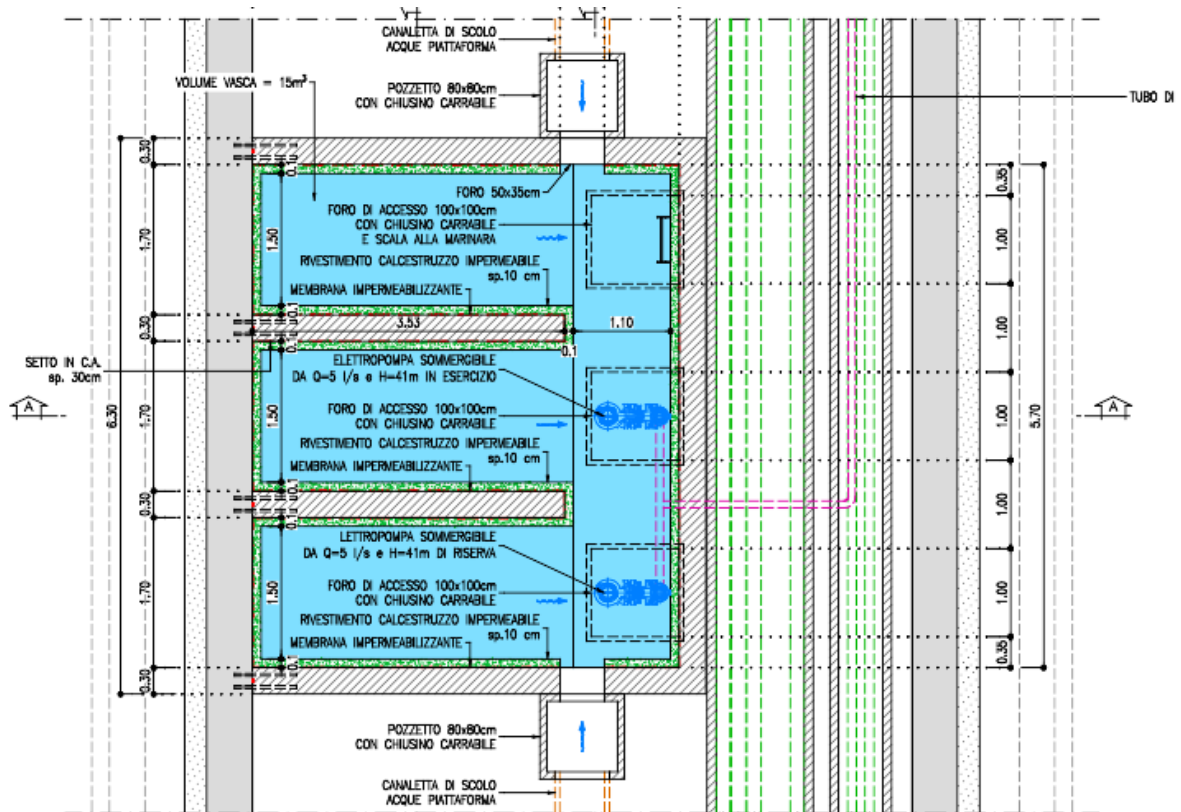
Pianta vasca di accumulo e sollevamento Forch
